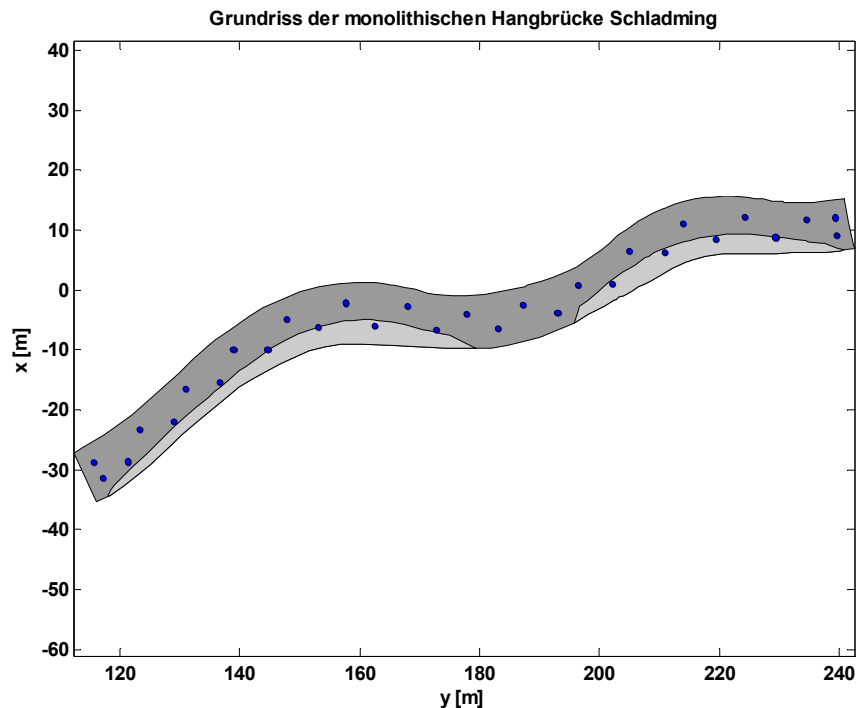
Grundriss der monolithischen Hangbrücke Schladming (Lienhart, 2007)
